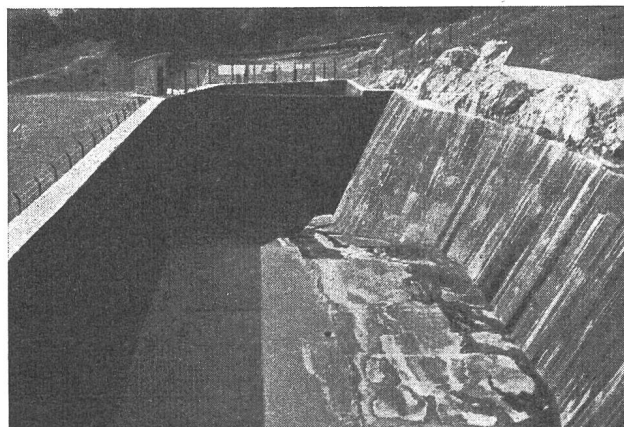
EW Massagno. Ausgleichsbecken, unterer Teil mit Fassung und Ueberfall.
